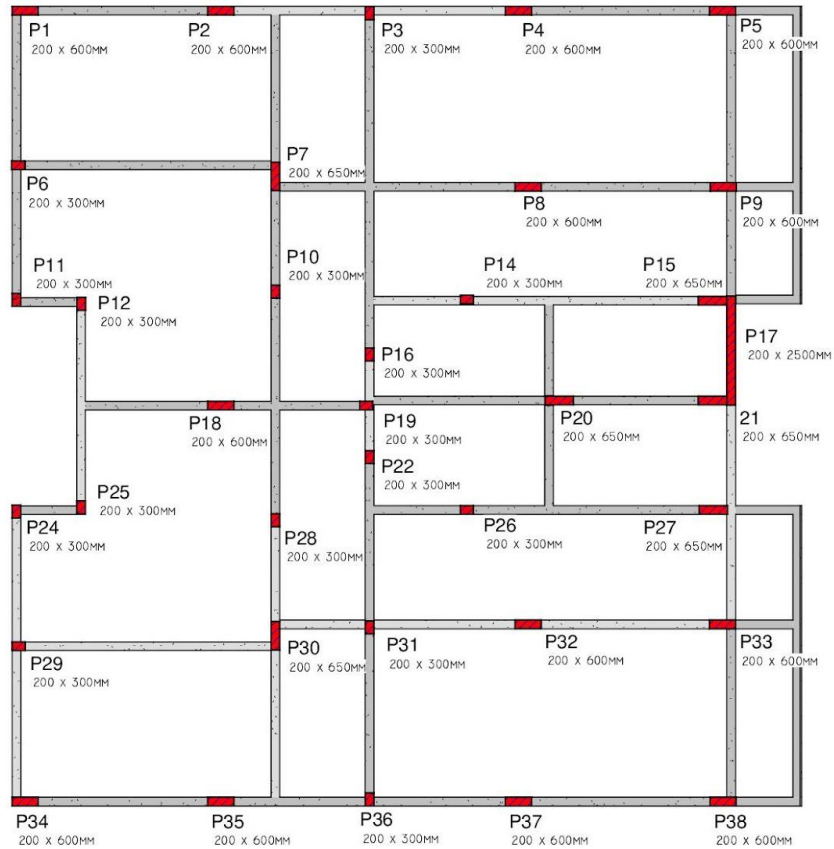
Planta, laje maciça concreto armado - Fonte: Os próprios autores
